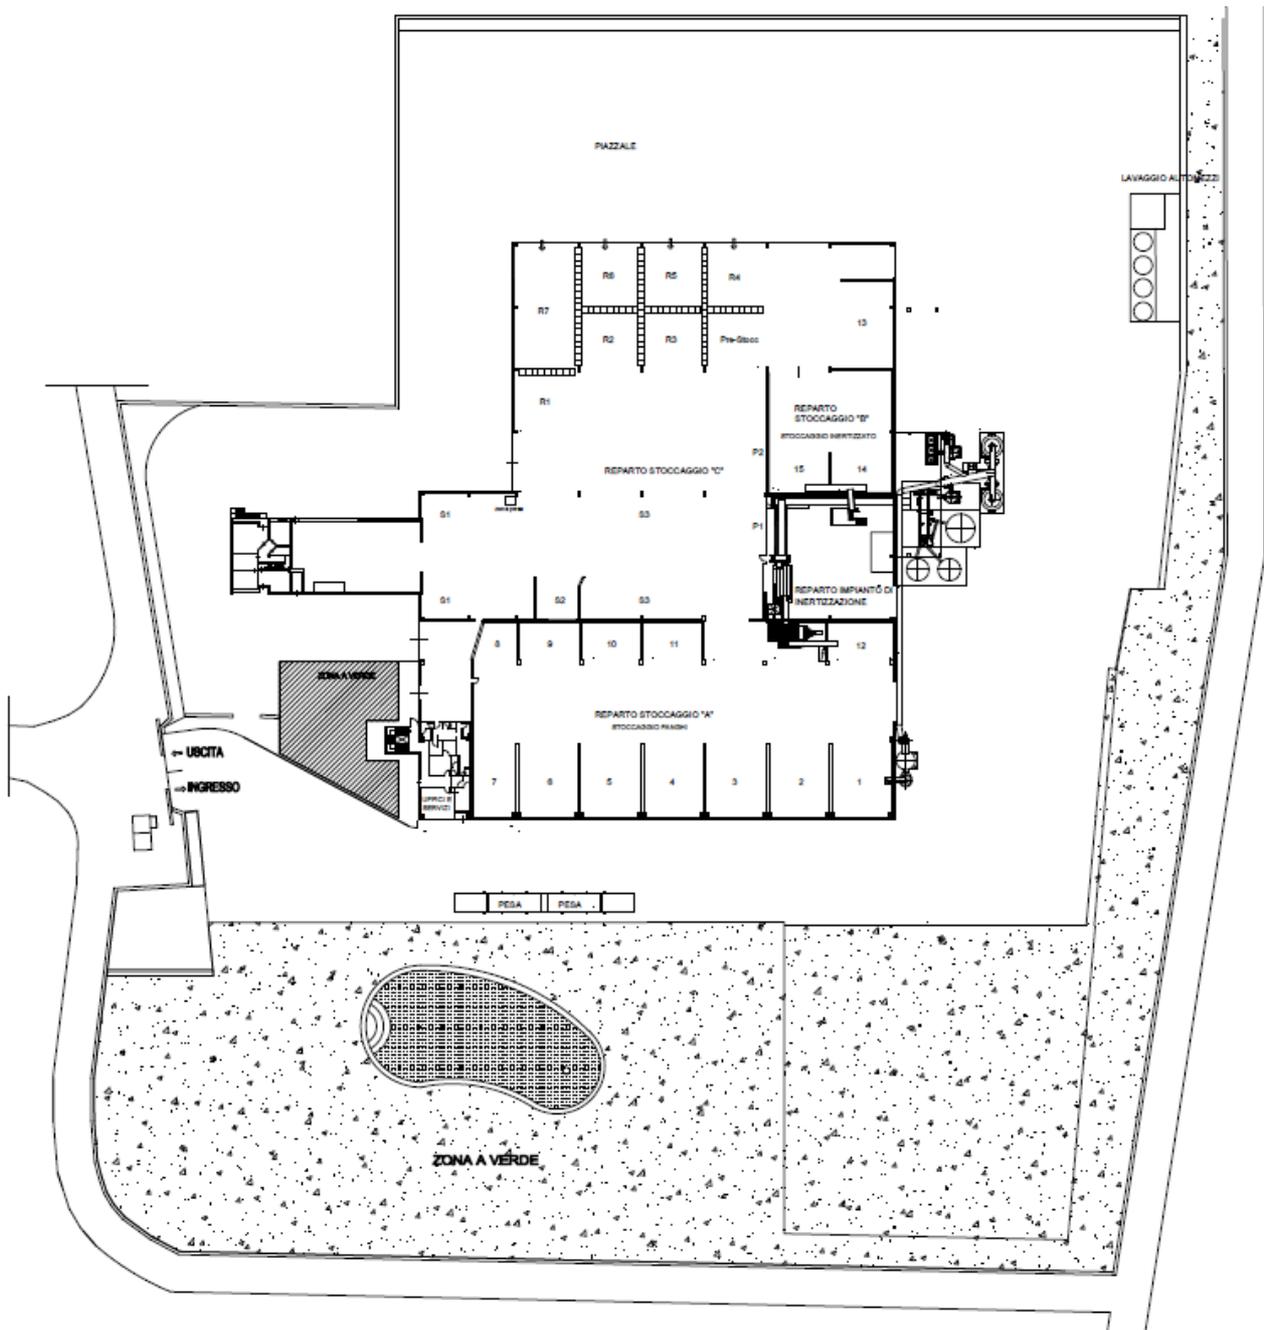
Planimetria generale dell’impianto HASI Castel Franco di Sotto – via Usciana
